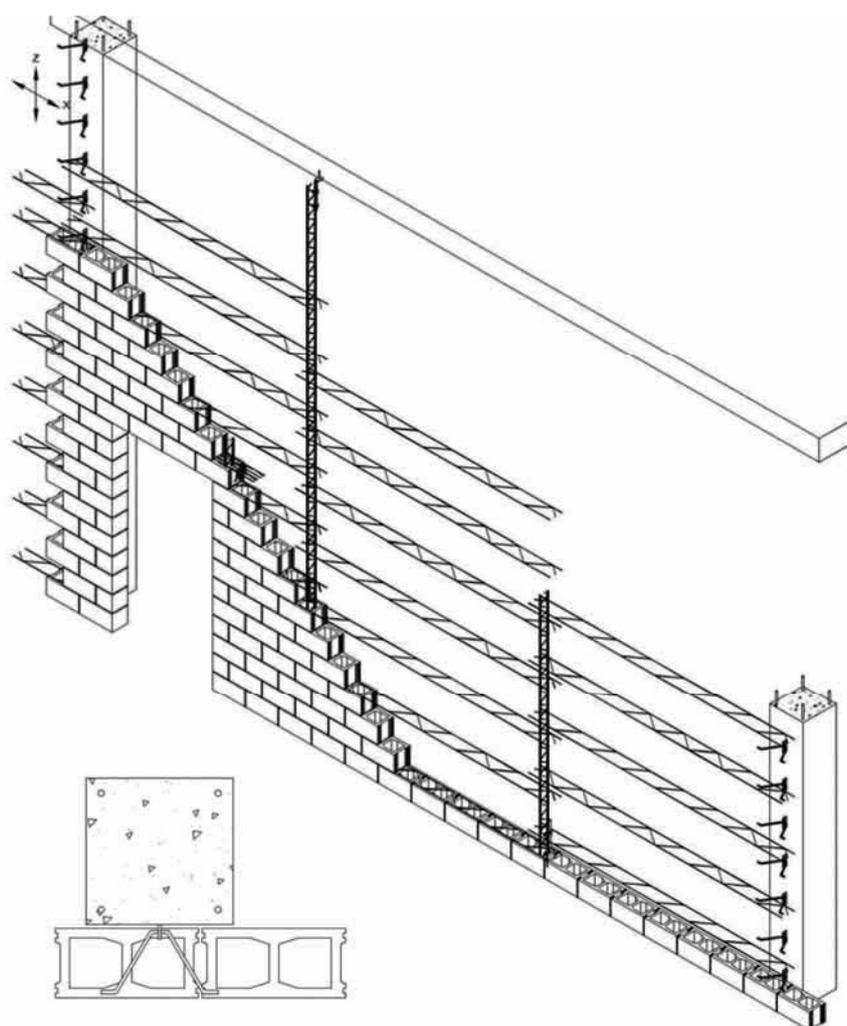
Perspectiva de muro de 1 hoja de cerramiento de gran altura con el Sistema de Albañilería Integral. Detalle del muro pasante con anclaje deslizante en las direcciones vertical y horizontal del plano del muro (X, Z).
